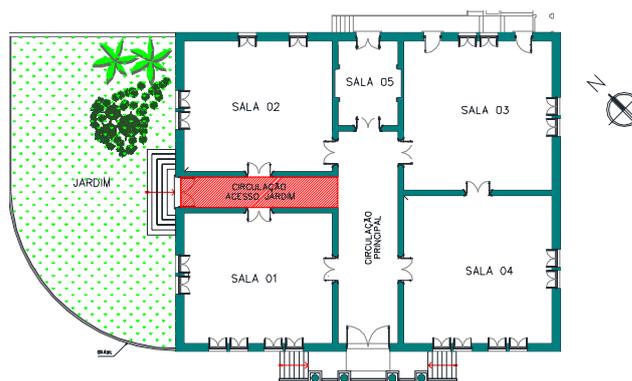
Circulação acesso ao jardim em destaque na planta baixa.
